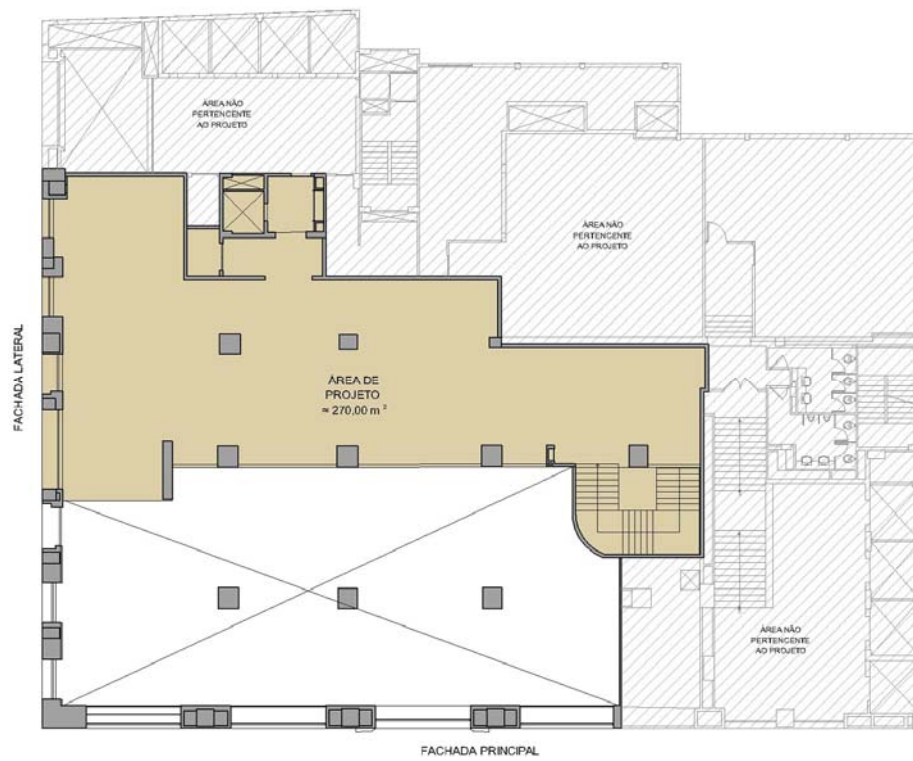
Planta baixa mezanino (limites da área de projeto)
